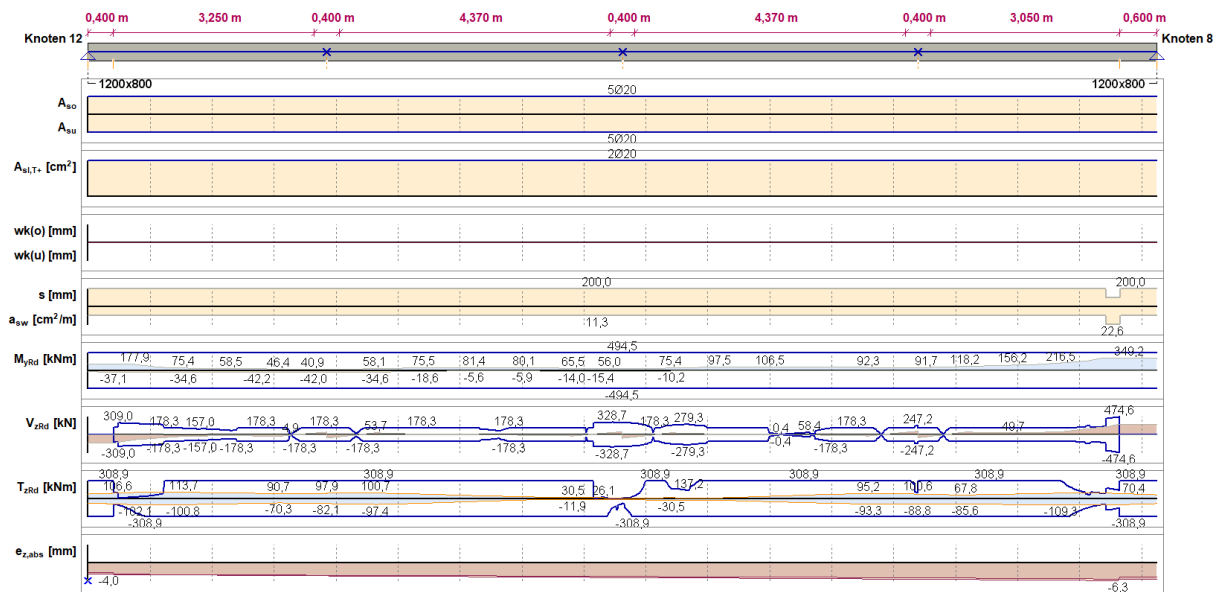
Berechnete Balkenbewehrung, Achse 7, vertikale Ebene
